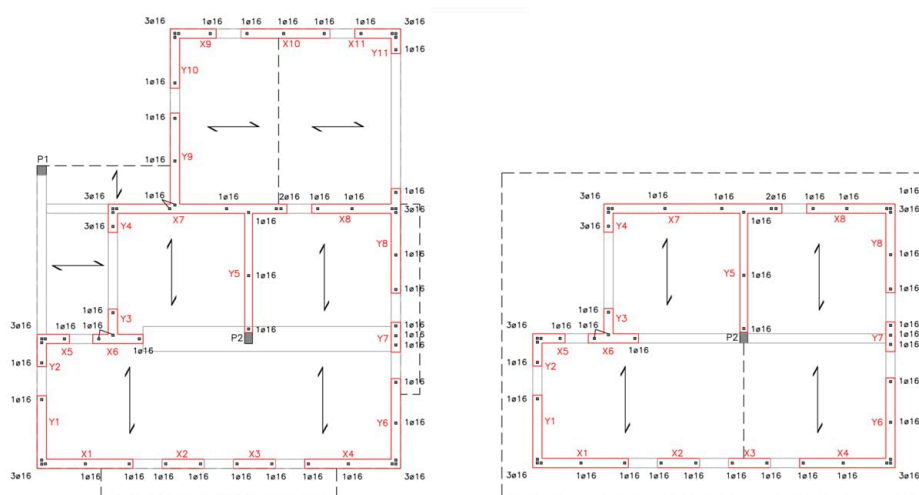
Pareti portanti in muratura armata POROTON®, con indicata la distribuzione delle armature e l'orditura dei solai (piano terra e piano primo).
